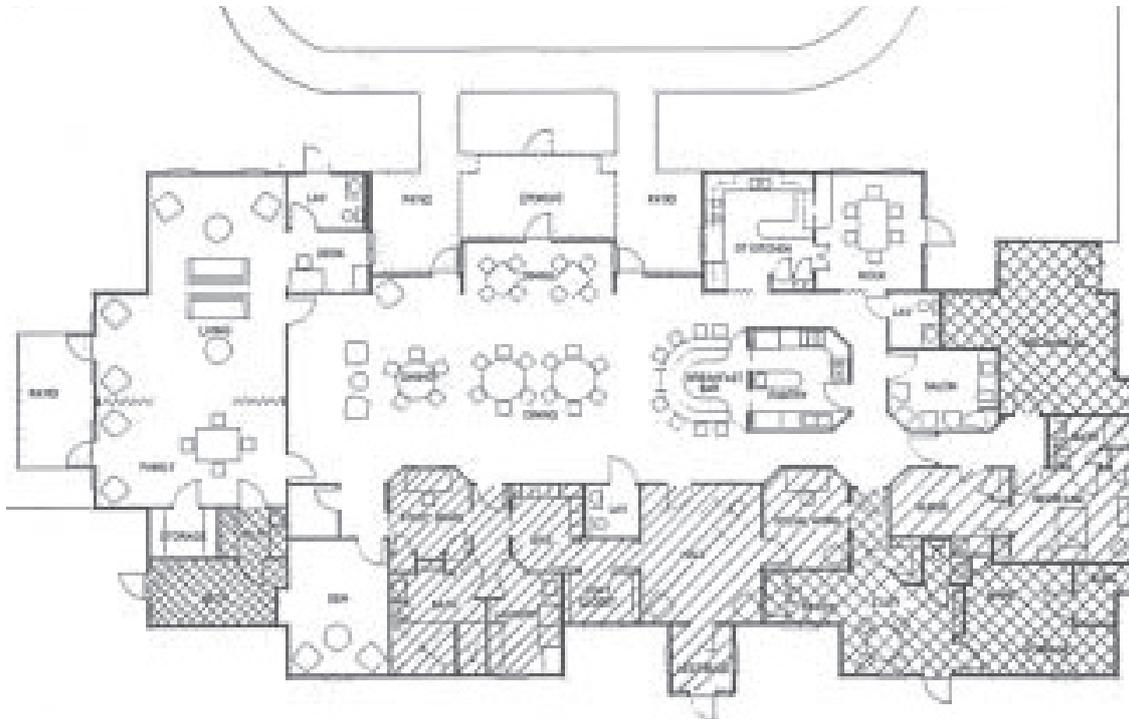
Planimetria del Louis Feinstein Alzheimer's Day Center
